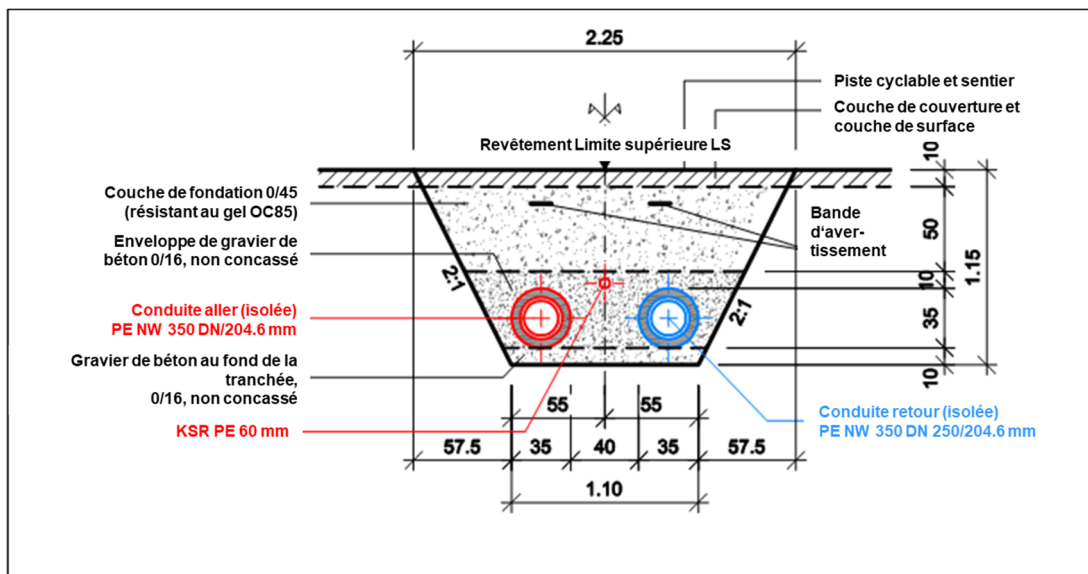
Profil typique d'une tranchée avec deux conduites isolées
